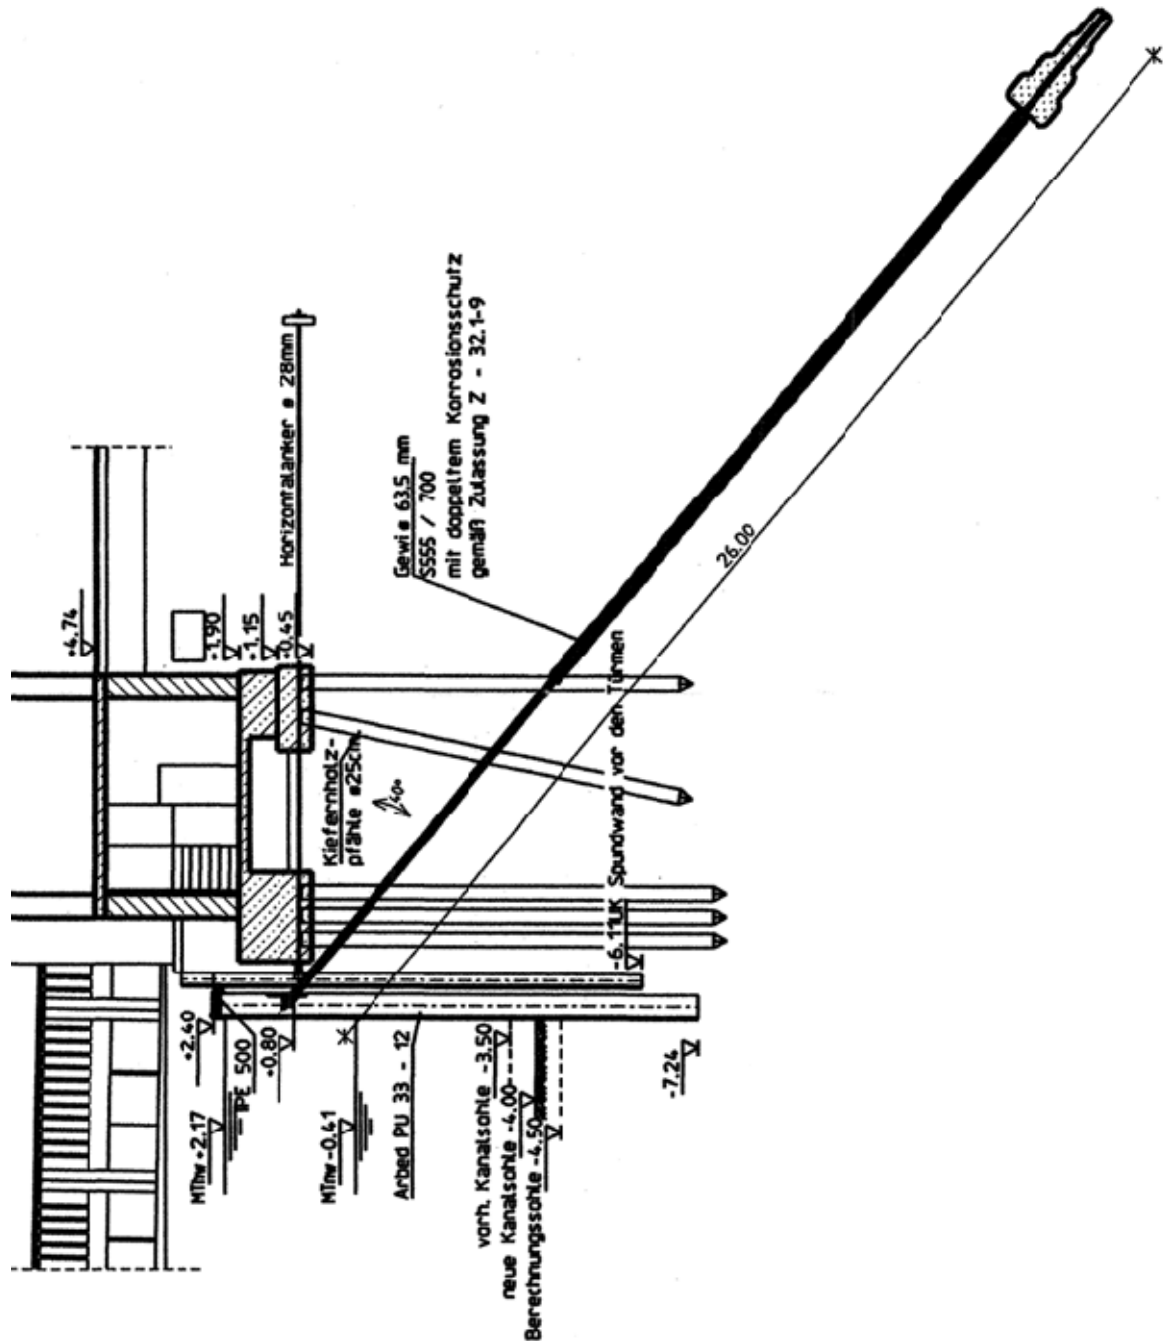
Neue Spundwand mit Rückverankerung (Ausschnitt aus dem Ramm- und Verankerungsplan Spundwand Uferstraße)
